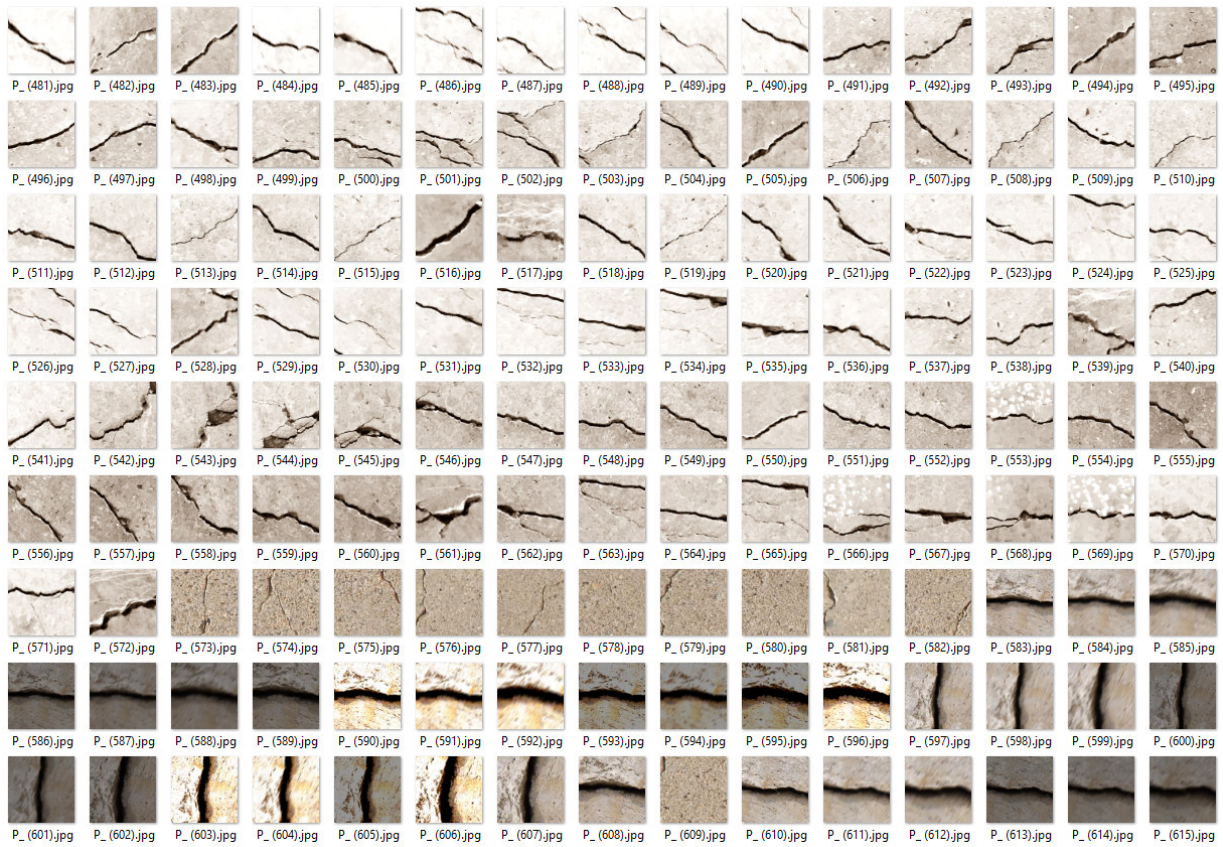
Amostra das imagens com fissuras da rede 1
